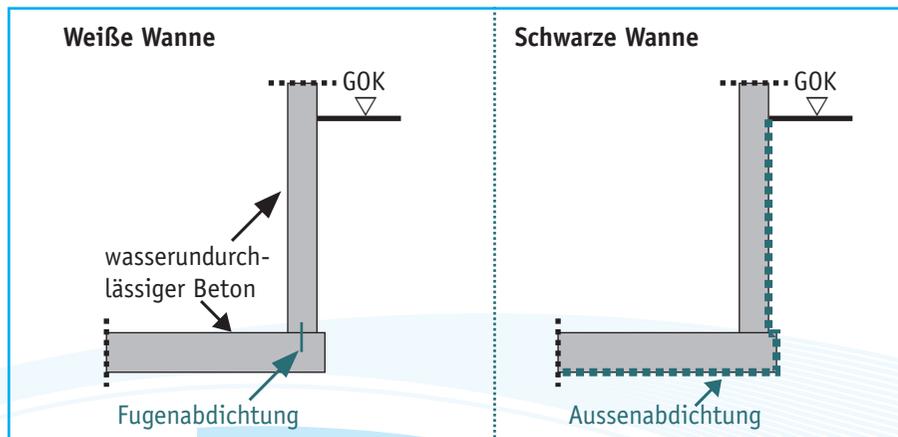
Schema des Aufbaus wasserundurchlassiger Kellerwande
